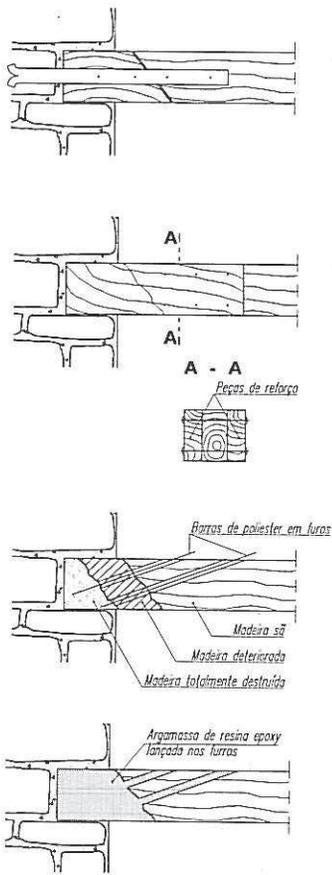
Solução típica de reforço de pavimentos de madeira.
